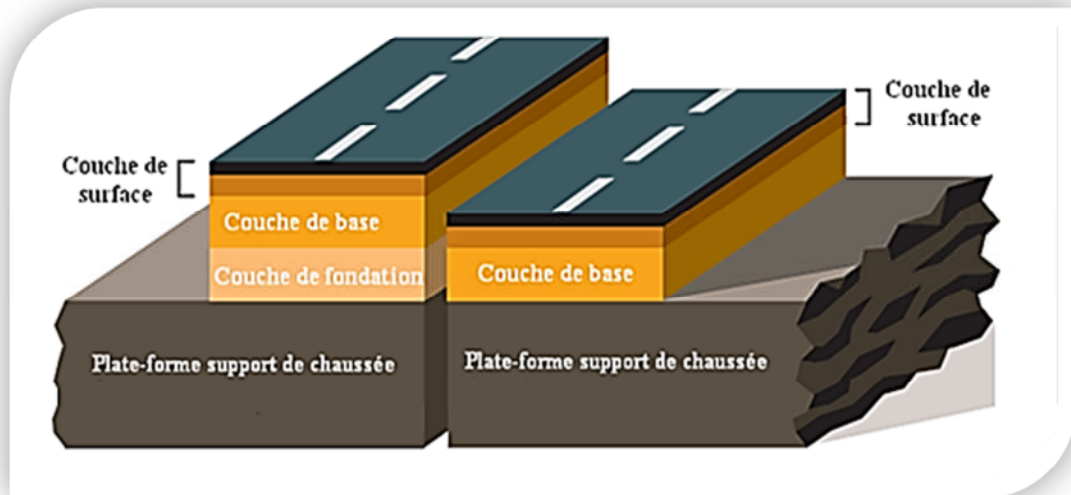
Structure type d'une chaussée semi-rigide.
